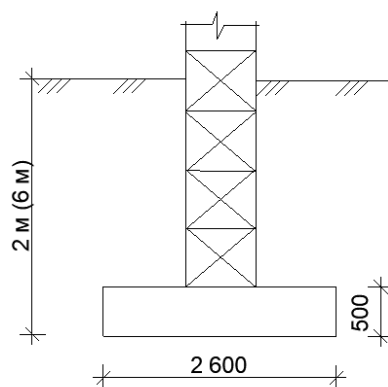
Схема фундаменту, що прийнята для моделювання суцільного ґрунто-пального масиву в межах умовного фундаменту
